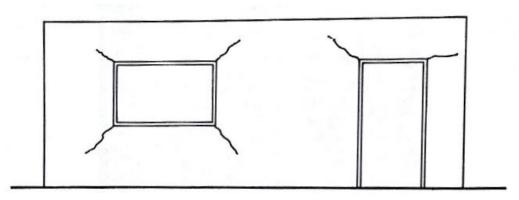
Fissura típica de falta de vergas e contra-vergas (THOMAS)
